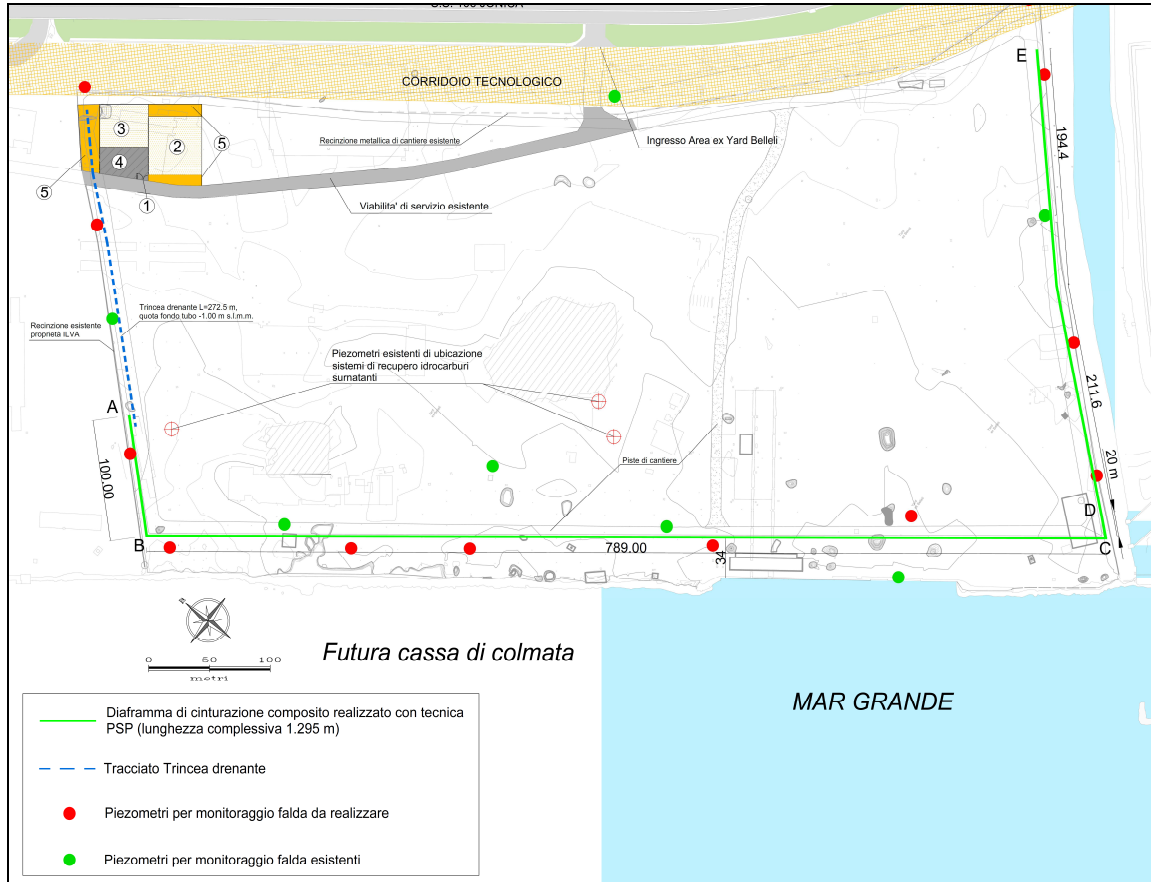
planimetria della rete di monitoraggio con piezometri
